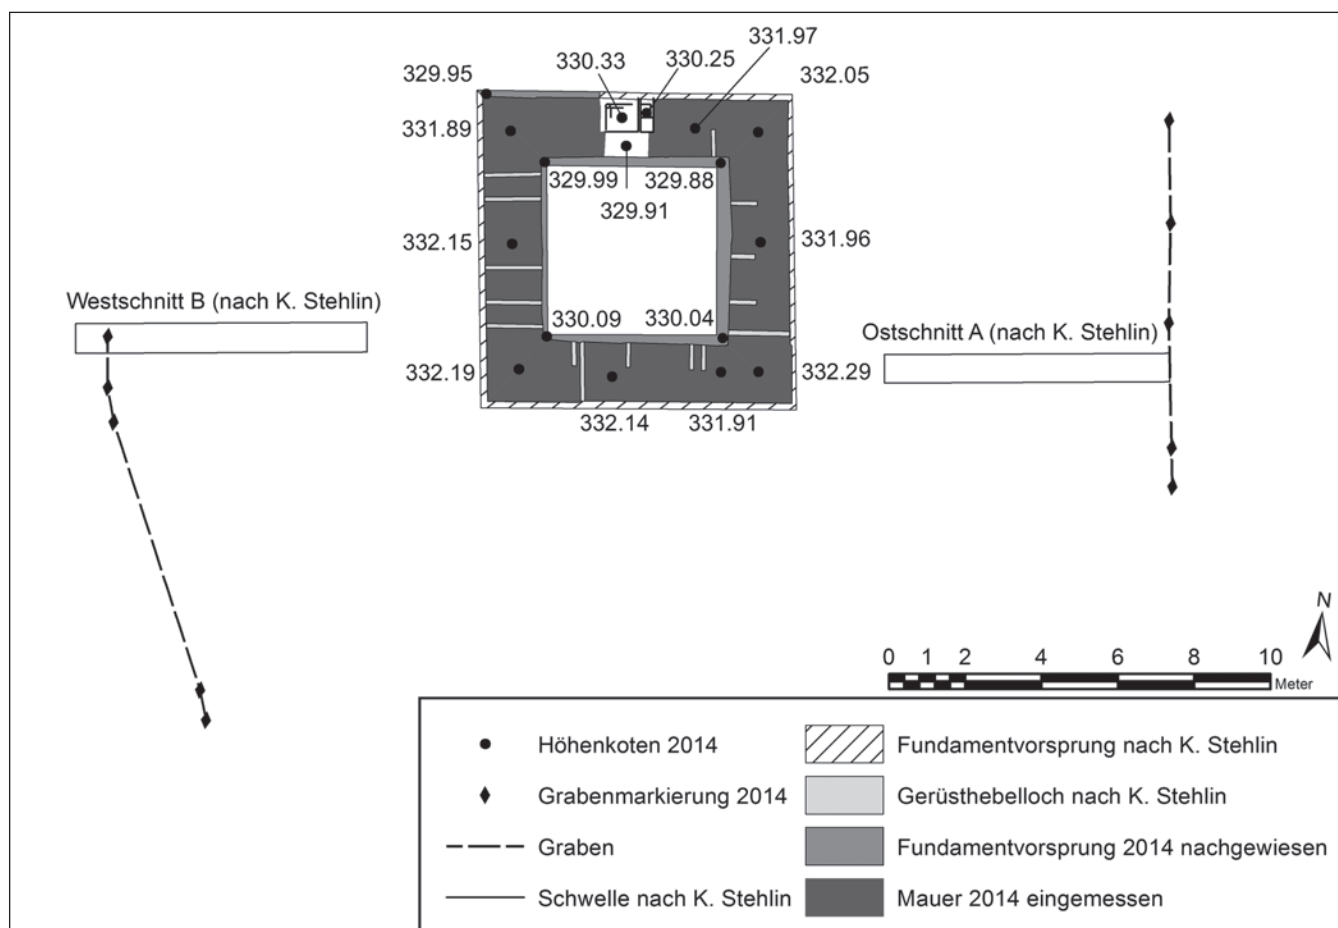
Koblenz-Kleiner Laufen (Kob.014.1). Im Rahmen der Sanierungsarbeiten neu vermessener und schematisch ergänzter Grundrissplan von K. Stehlin.
